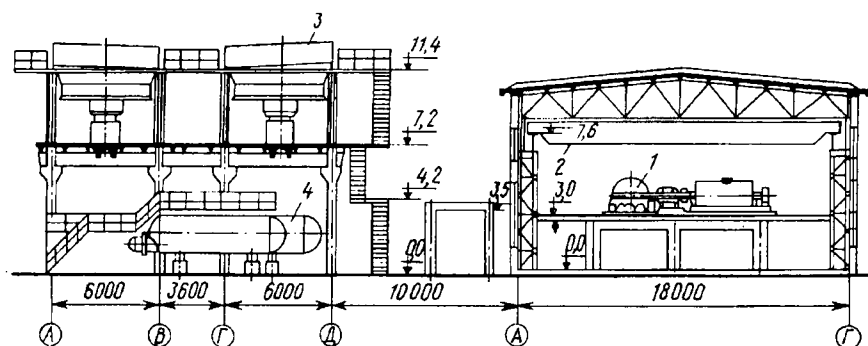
Разрез машинного отделения и открытой площадки пропановой холодильной установки:
